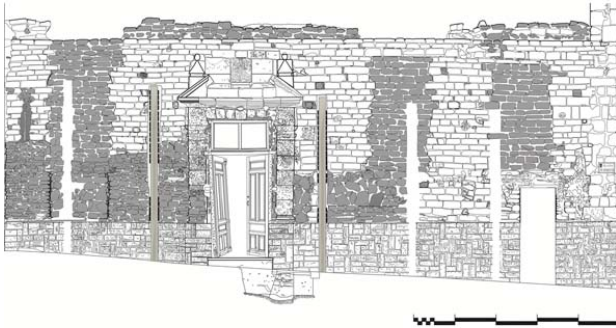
Alzado cara externa muro de fachada. 2009. ARQVIPO.
